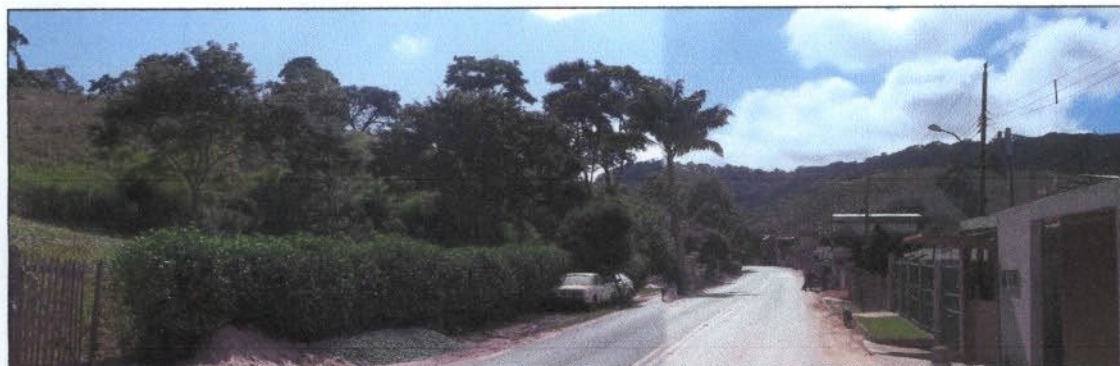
Vila Novo Paraíso. Local previsto para travessia do mineroduto sob a BR.
